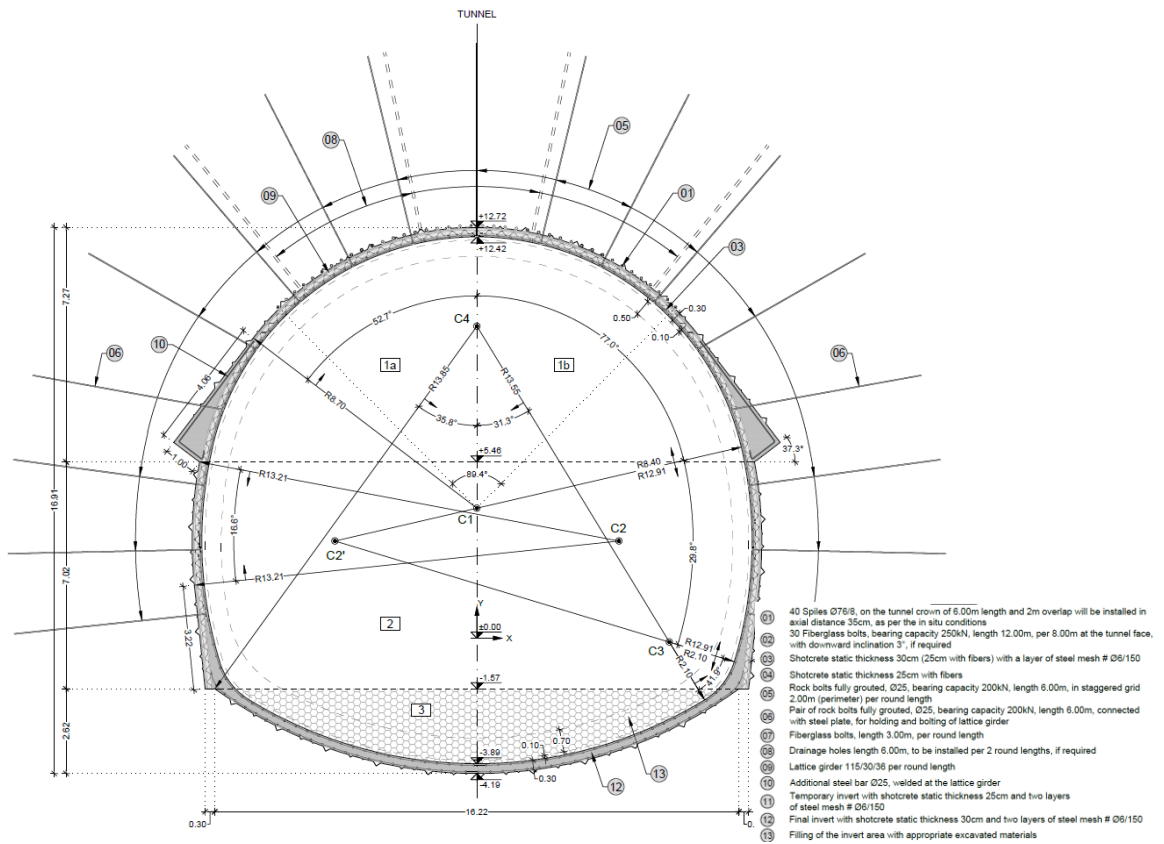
Escavação e Apoio Inicial do Túnel Transversal 2
